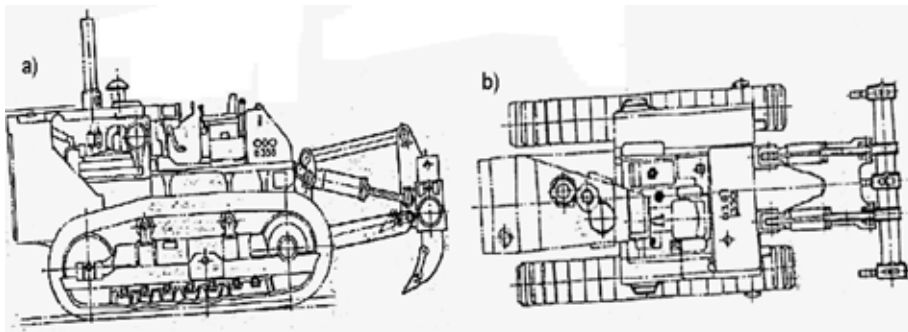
Tractor con escarificador. a) Sección longitudinal b) Vista en plano
